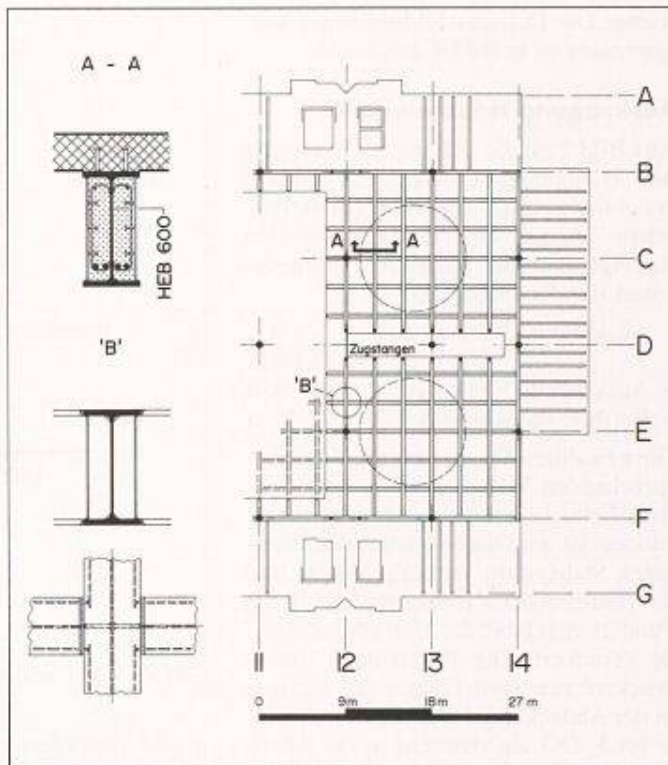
Grundriss sowie Querschnitt und Detailansicht Trägerrost-Verbunddecke
